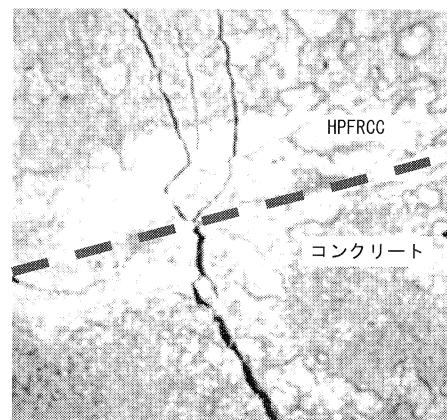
HPFRCC で細かく分散するひび割れ
